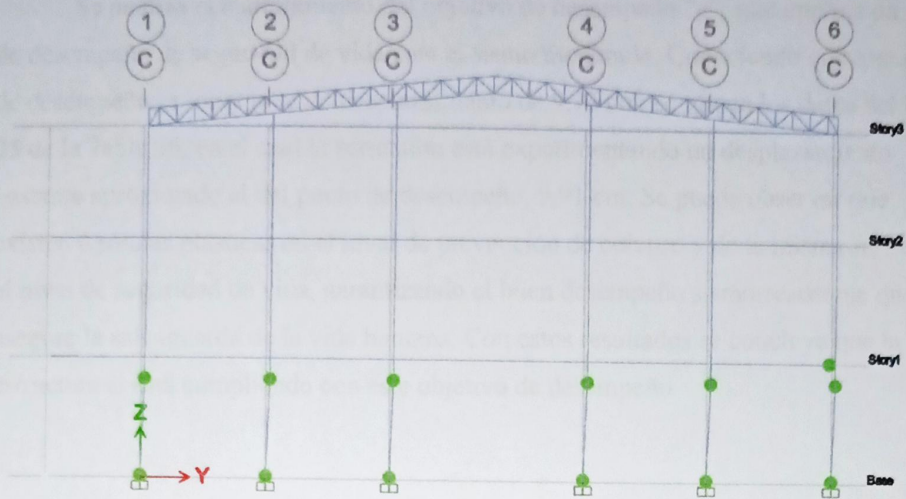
Rótulas plásticas del pórtico C del modelo estructural sin mampostería en la dirección Y, sismo de diseño
